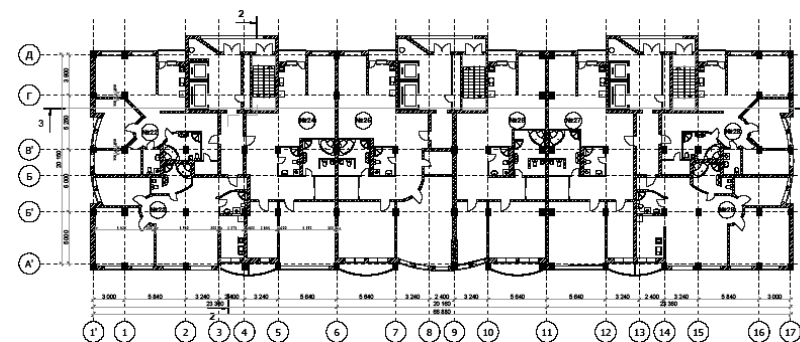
Схематический план 7-15 этажей здания по Запорожскому шоссе, 9 в г. Днепропетровске после реконструкции с применением железобетонного каркаса
